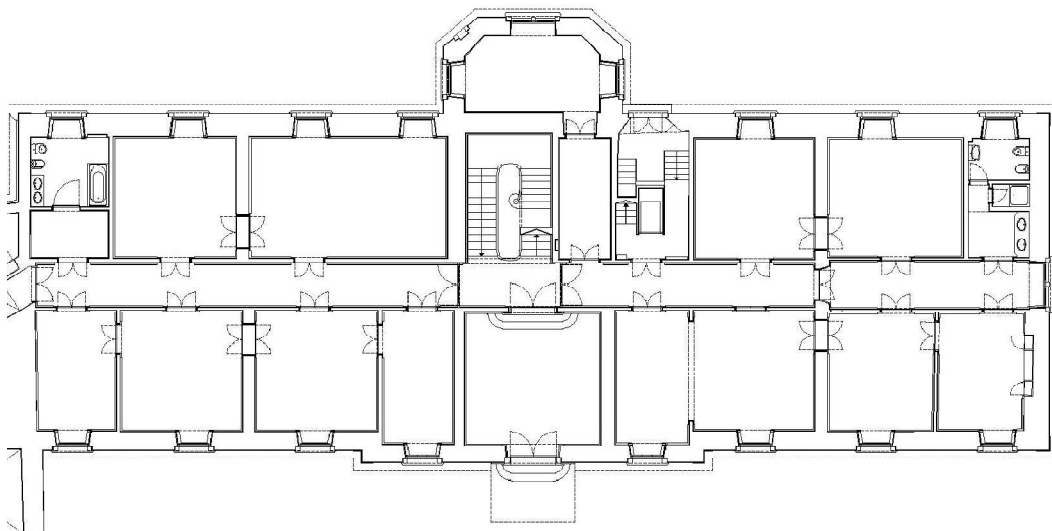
Planta dos pisos elevados, retirada do levantamento arquitetónico (TOPOMETRIA, 1998).
